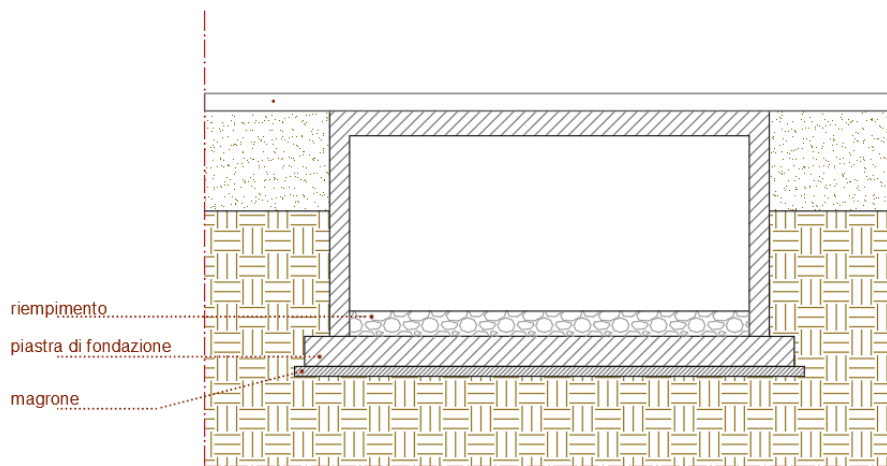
Sezione tipo tombino scatolare per attraversamenti carrabili.
